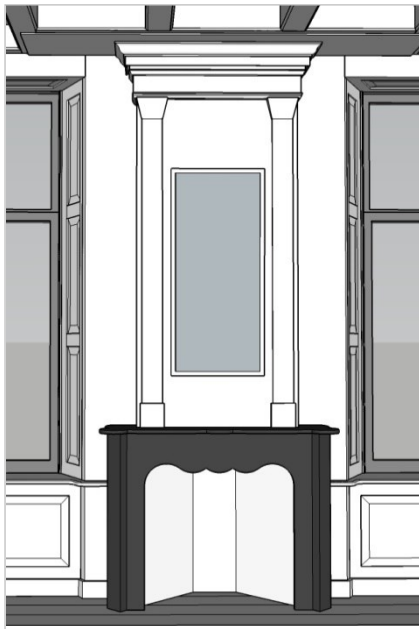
Plafond (6): neem afstand door even door de knieën te gaan
